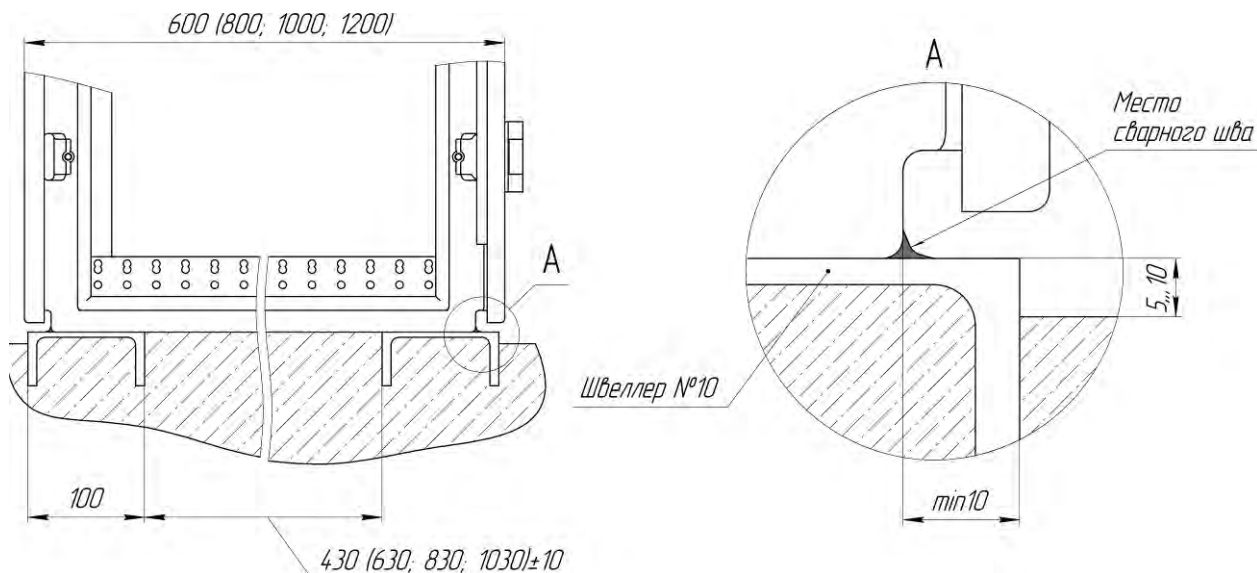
Крепление ГРЩ к закладным элементам при помощи сварки
